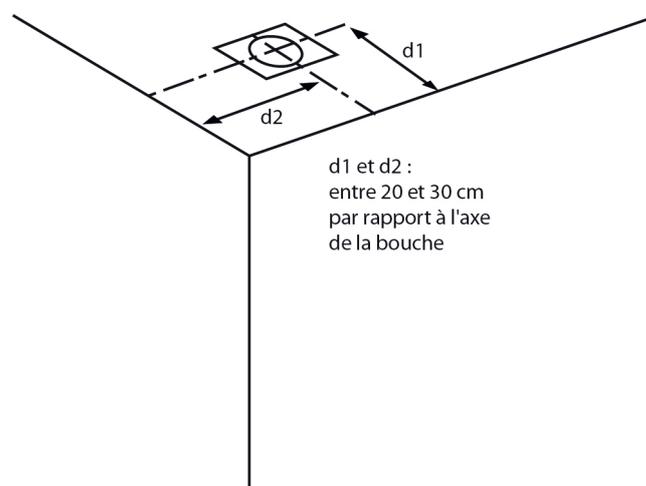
3 : Exemple d'installation d'une bouche de soufflage sous un rampant
